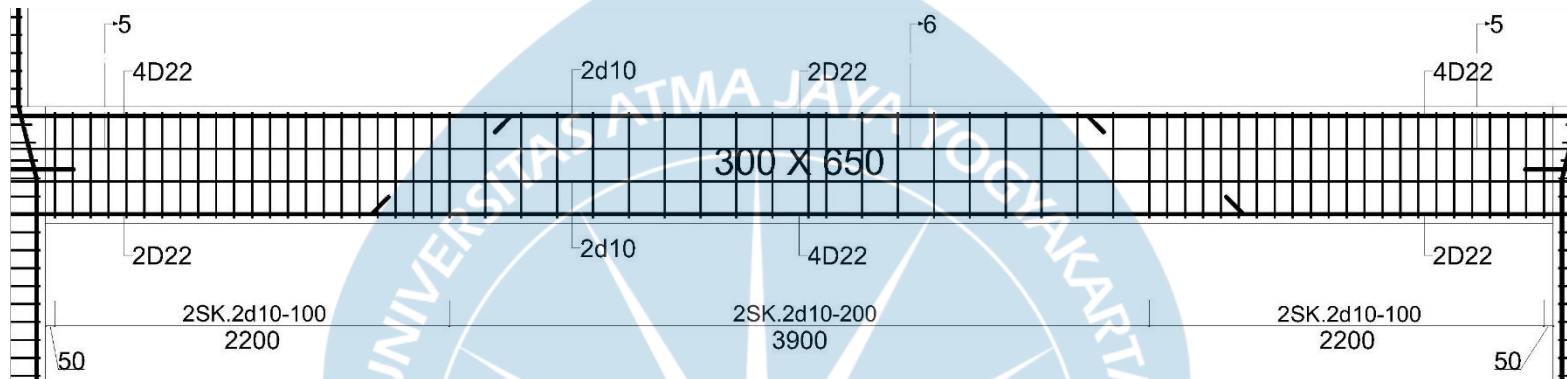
Detail penulangan kolom-balok lantai 1 as A dan B
